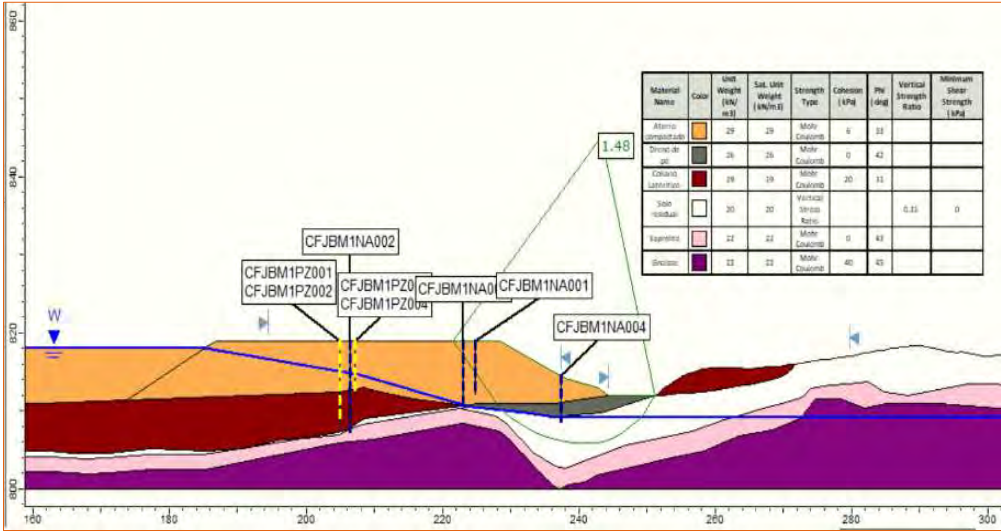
Seção A-A - Condição Não Drenada - Superfície não circular - FS = 1,48.
